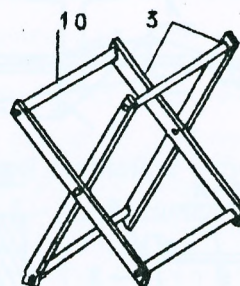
Усиление балок при помощи крестообразных хомутов: 1 – верхние пластины; 2 – несущая конструкция; 3 – хомуты; 4 – закладные детали; 5 – стержни; 6 – нижние пластины; 7 – тяжи; 8 – хомуты; 9 – кронштейны; 10 – цилиндрический шарнир.
